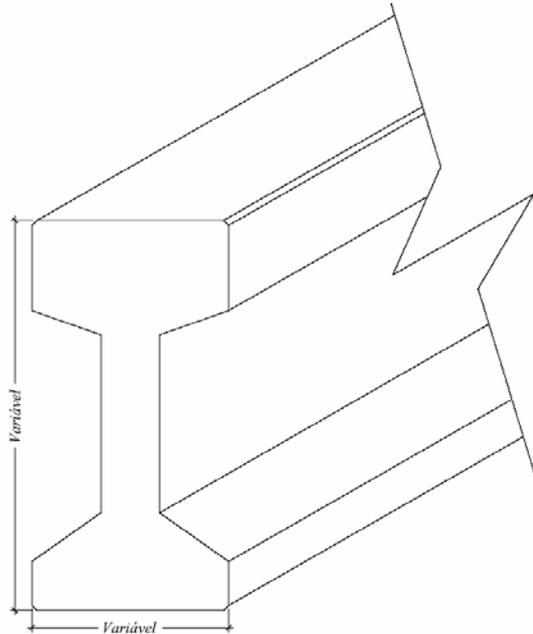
Detalhe da seção da viga “I” de cobertura.
